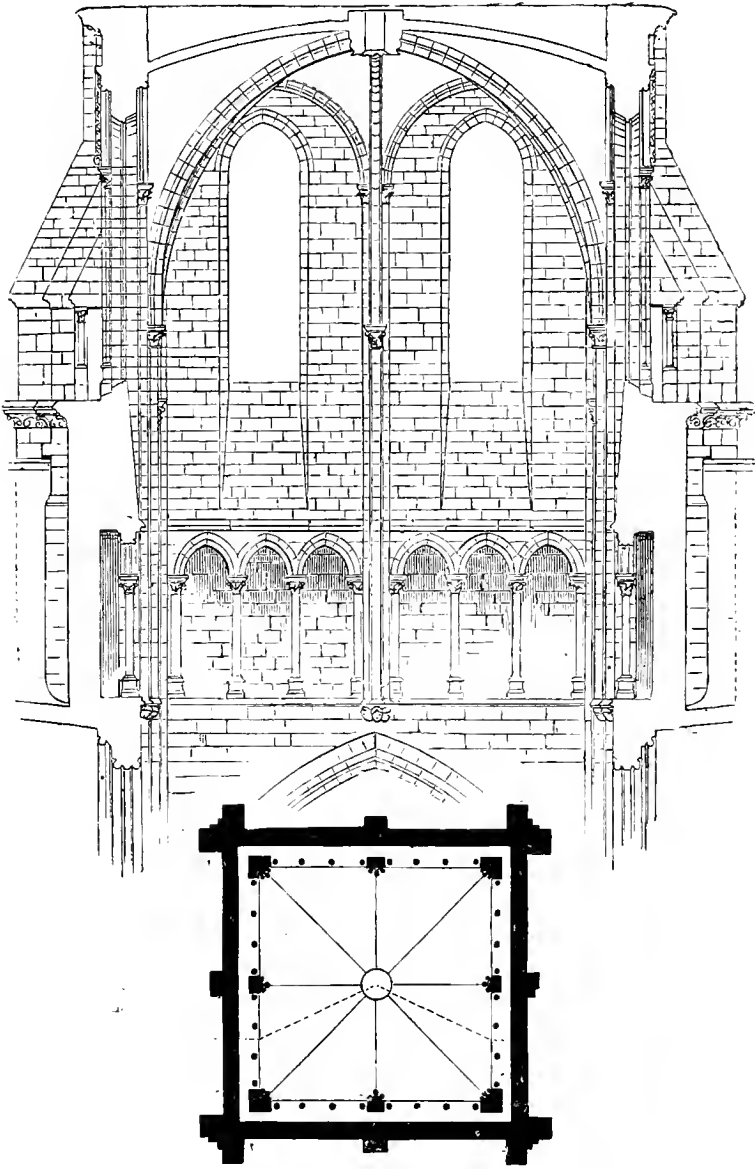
Plan et coupe de la tour-lanterne de la cathédrale de Laon.
